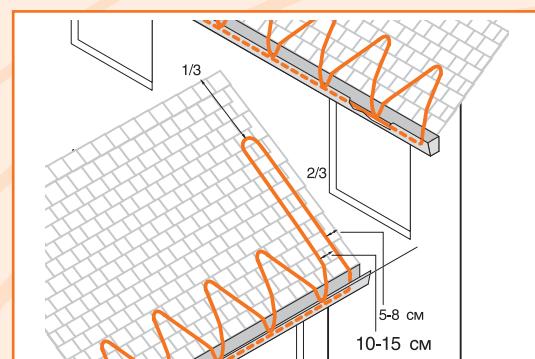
Укладка кабеля при примыкании кровли к стене
